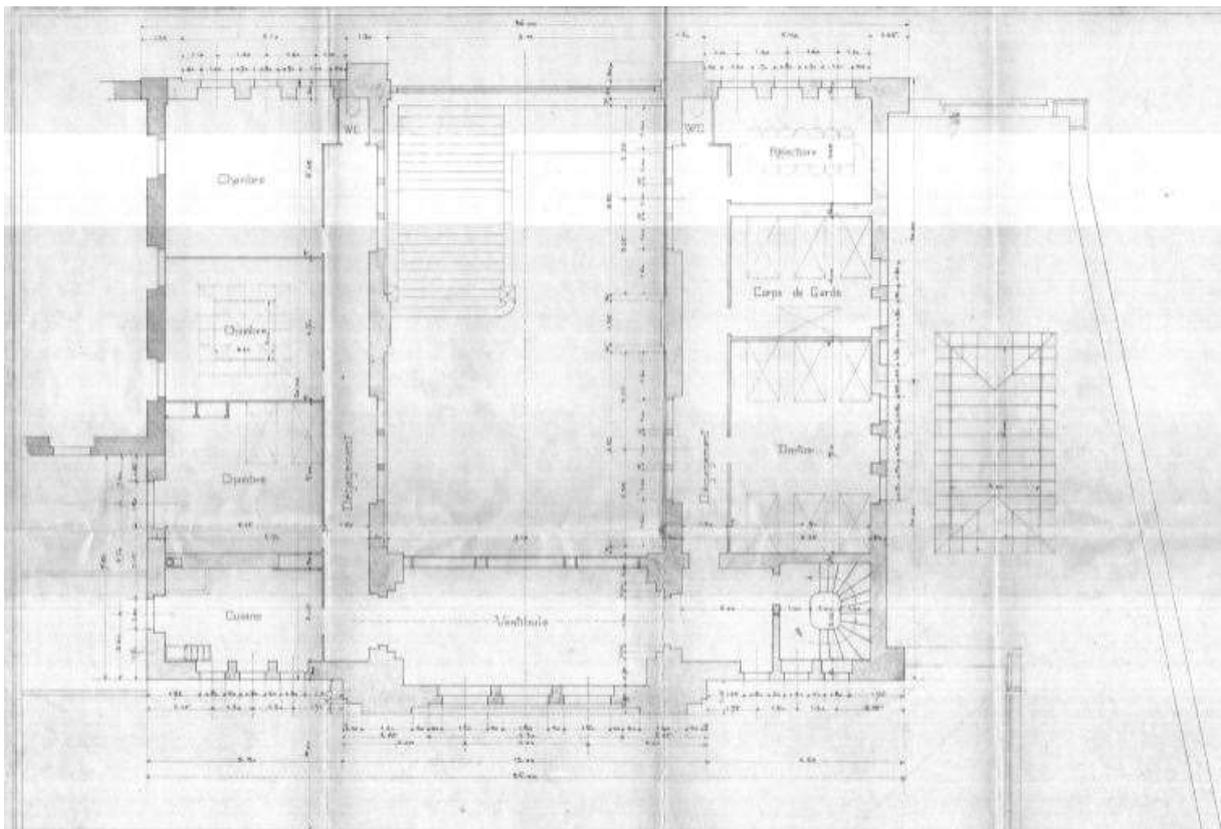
Nouvelle gare de Vevey, plan du rez-de-chaussée, Charles Coigny architecte, 13.8.1908 (CFF Lausanne Immobilier, SBB-IM-WEST 18000/101).
